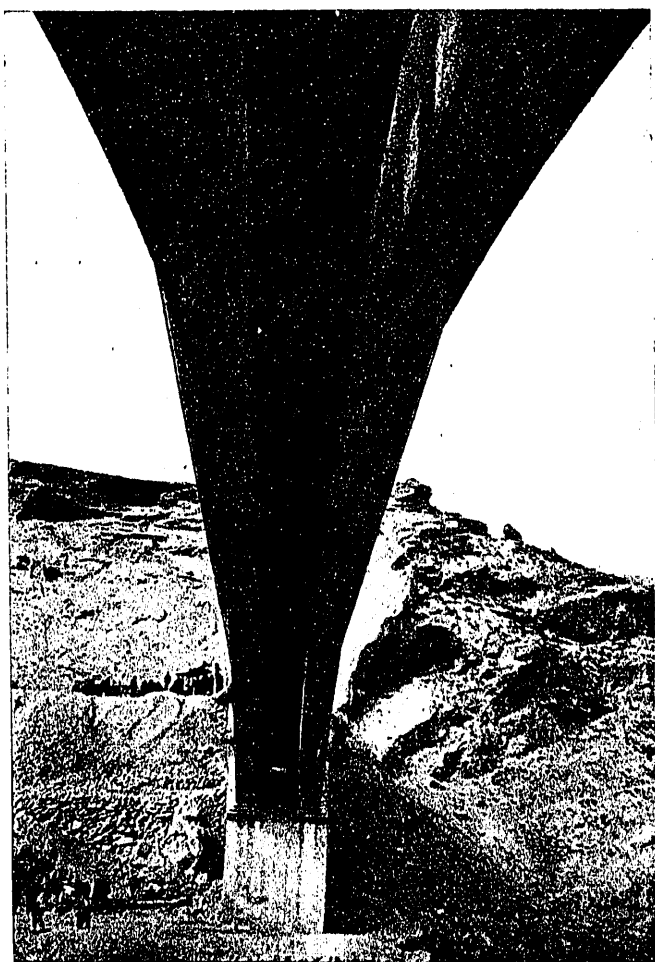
Las bóvedas gemelas, vistas por el intradós
